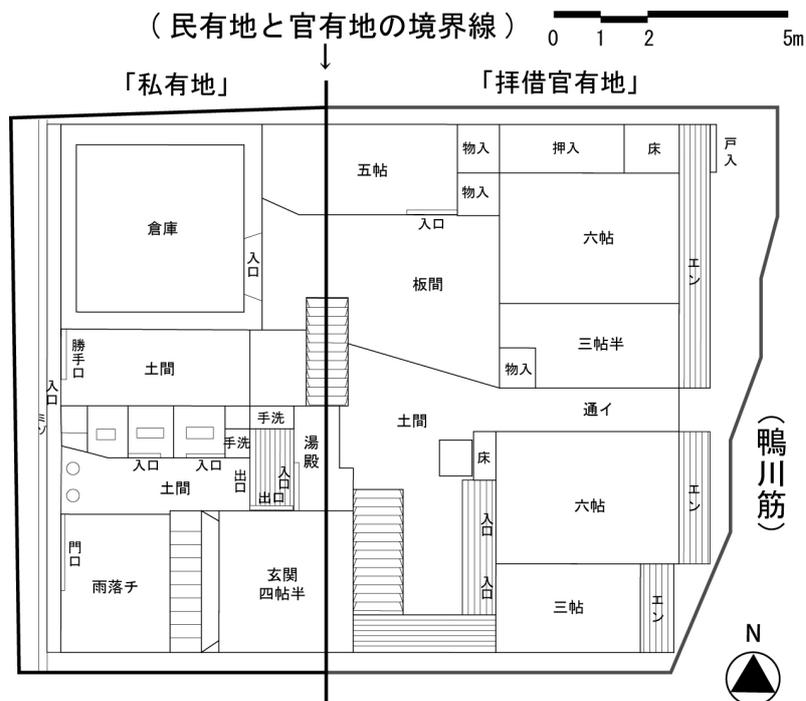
官有地と民有地に跨って建つ料理屋の平面図
